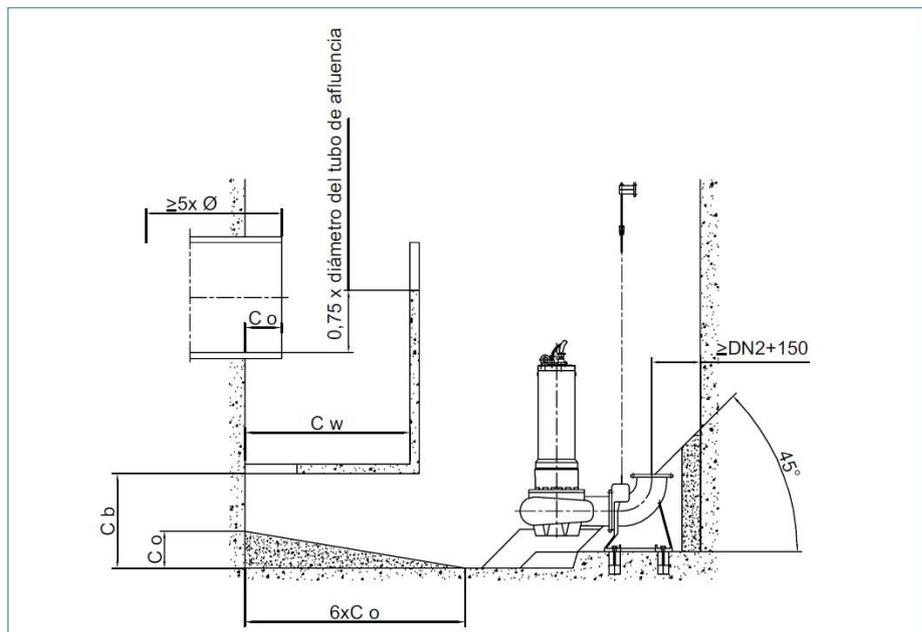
Dimensionamiento del pozo llegada frontal (corte)
